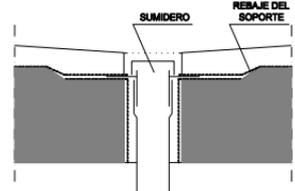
Rebaje del soporte alrededor de los sumideros
